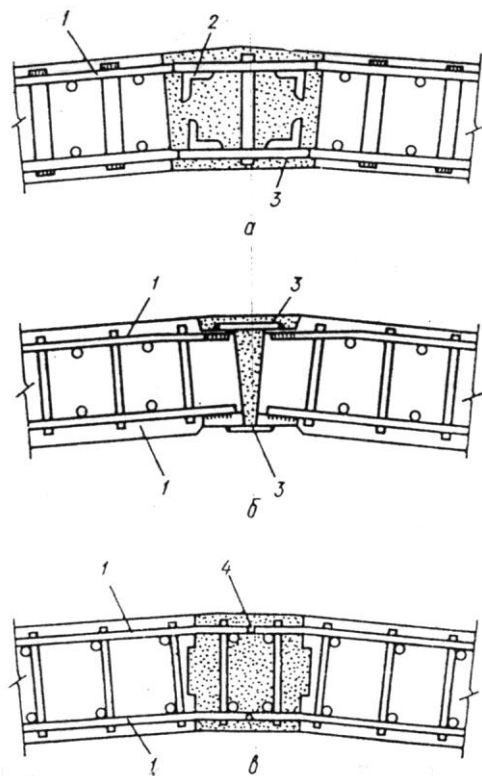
Стики збірних стін: а- із перехідним кутком; б- на сталевих накладках; в- із ванним зварюванням стрижневої арматури; 1- подовжня арматура; 2- перехідні кутки; 3- накладки; 4- ванне зварювання.
